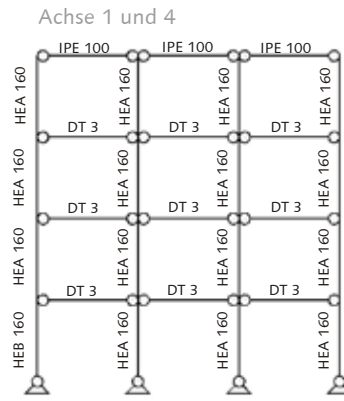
Grundriss Gelenk II - Haus 1
